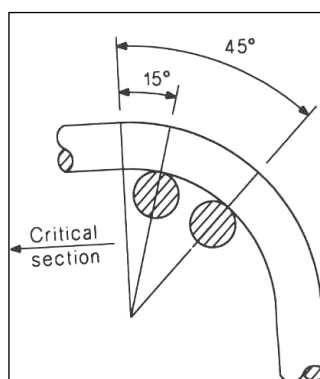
Arreglo de armadura transversal adicional para reducir las tensiones de apoyo en el hormigón por el gancho. Fuente: C. Llopiz, 2001, p. 90.
